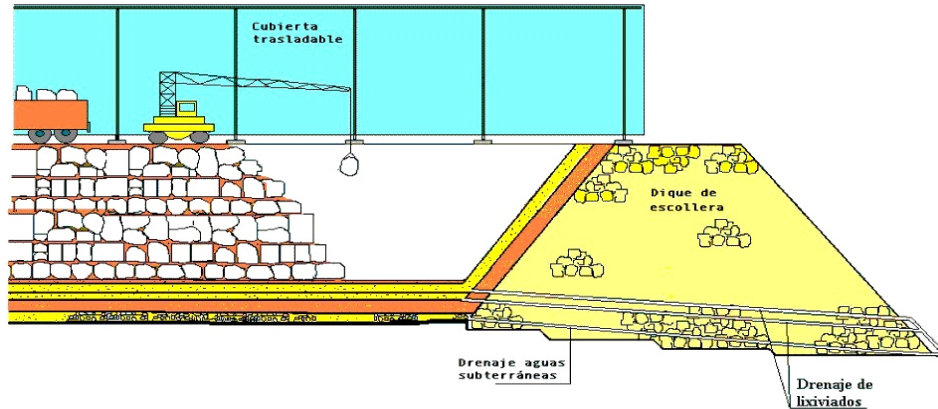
Detalle de una celda de almacenamiento de RBBA en construcción.
